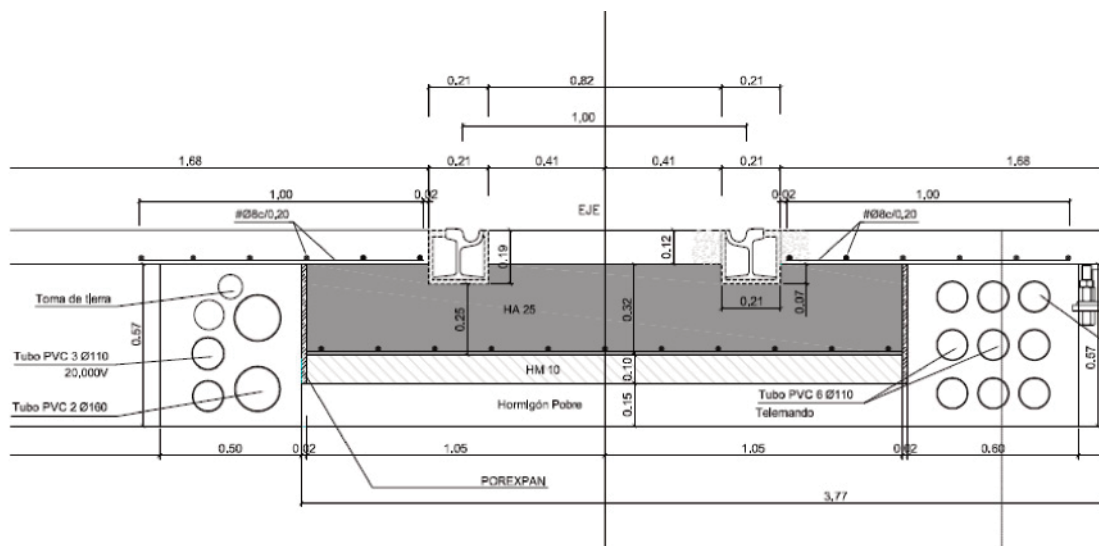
Vista transversal de la sección B1. Fuente: GTP
